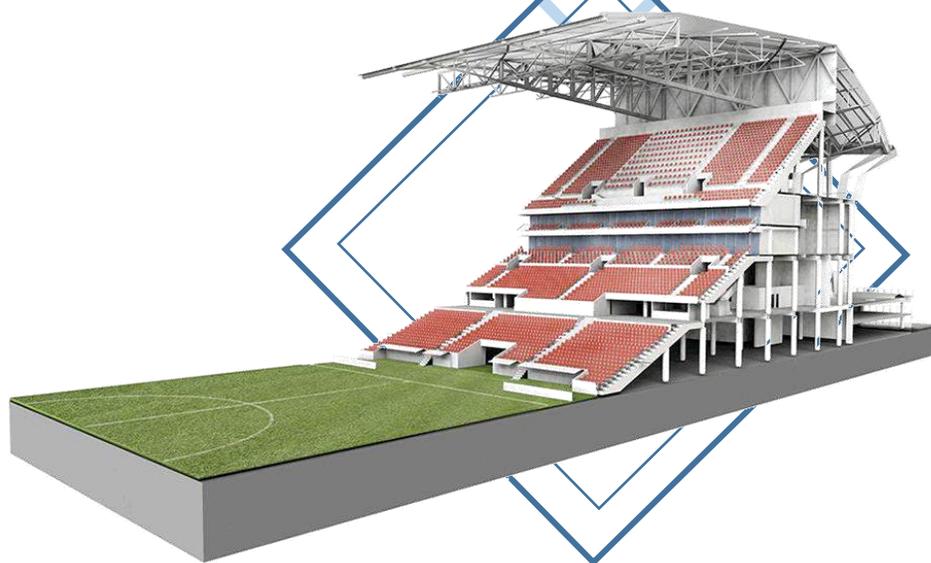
Detalle de cubierta del estadio “Stade des Lumières” en Francia.
